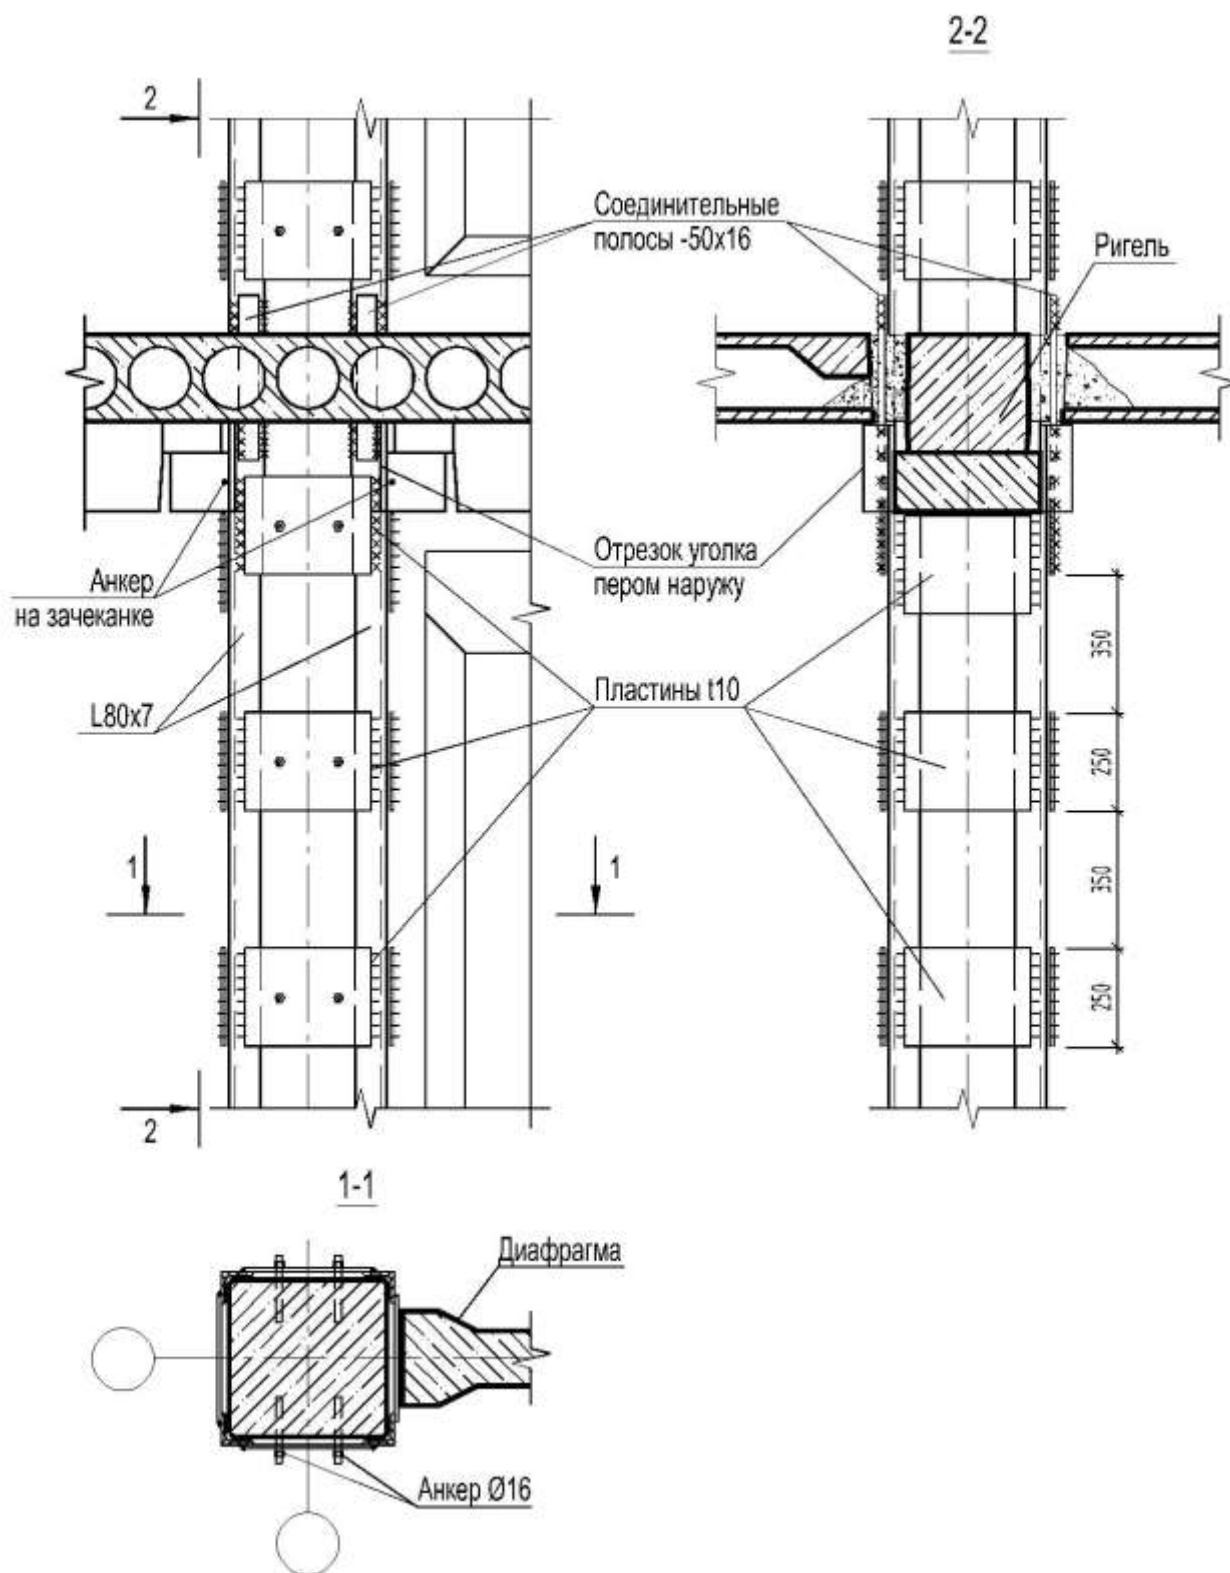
Колонны усиленные стальными обоймами, соединенными друг с другом при скрытых консолях или без них
